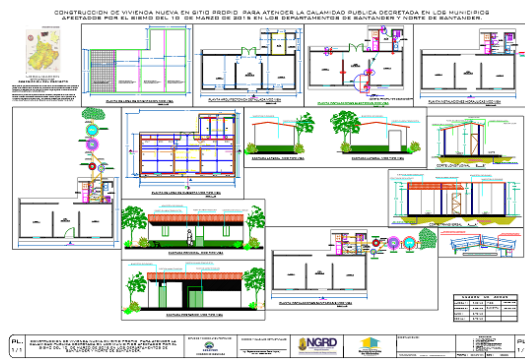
Plano Arquitectónico tipo 2 VIVA
